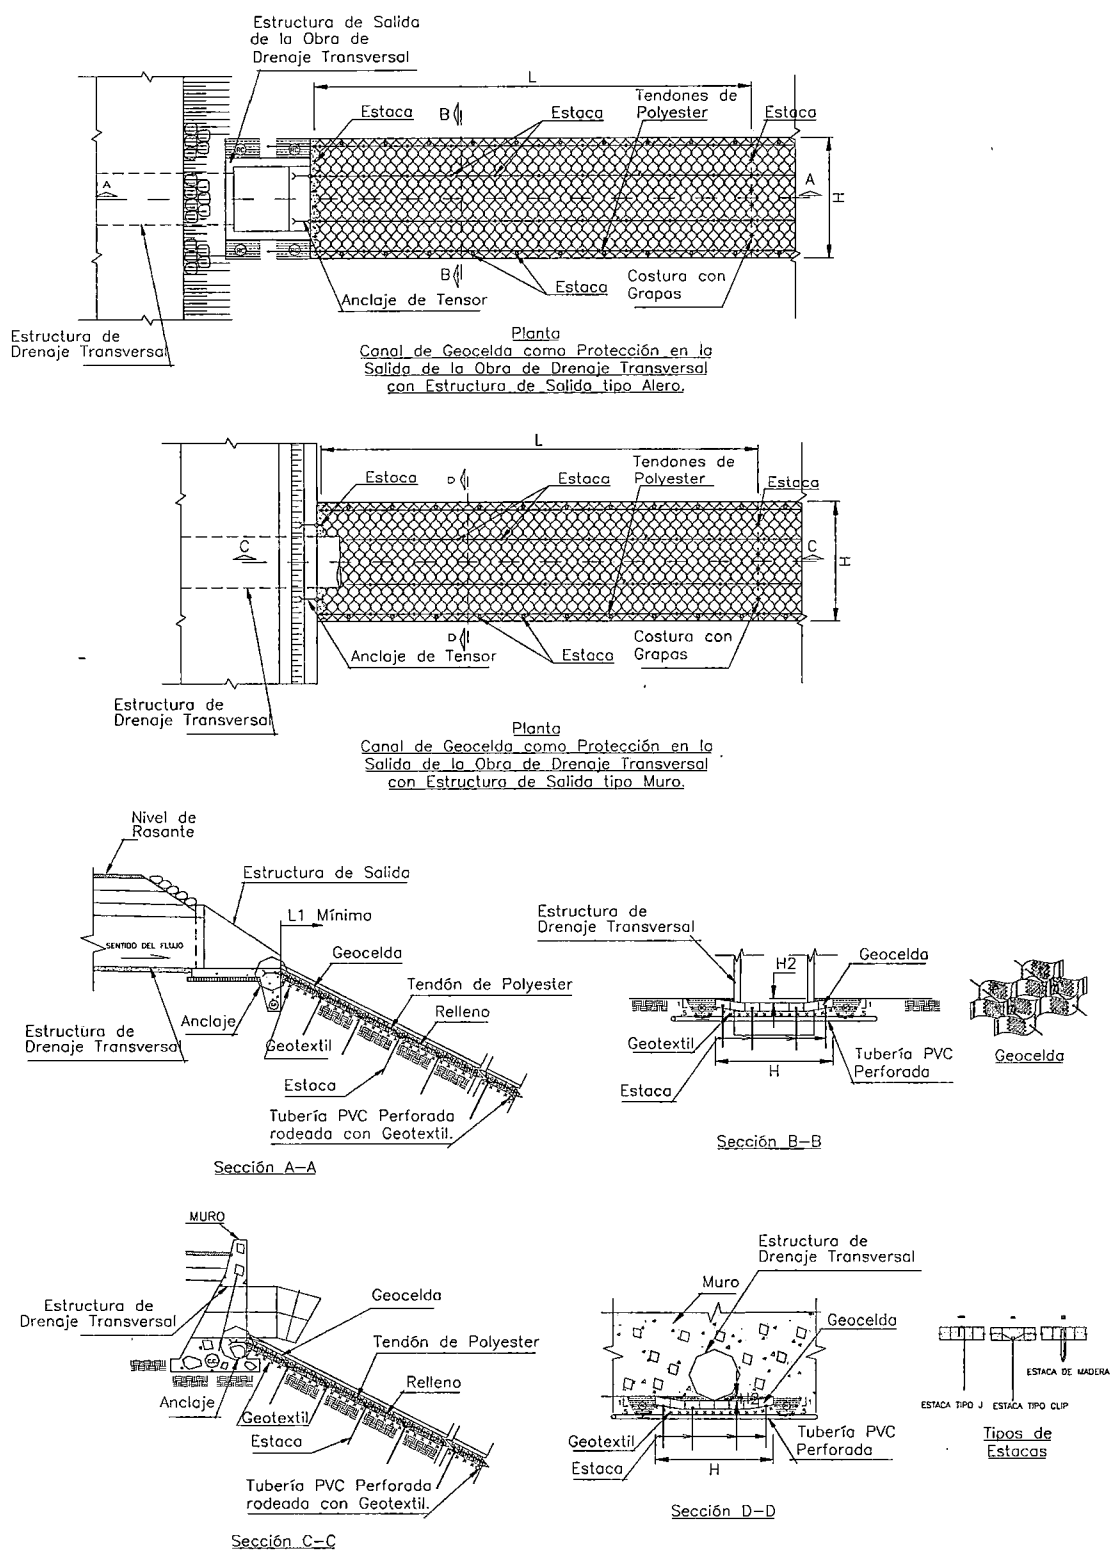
Protección con Geocelda en la Salida de la Estructura de Drenaje Transversal.
